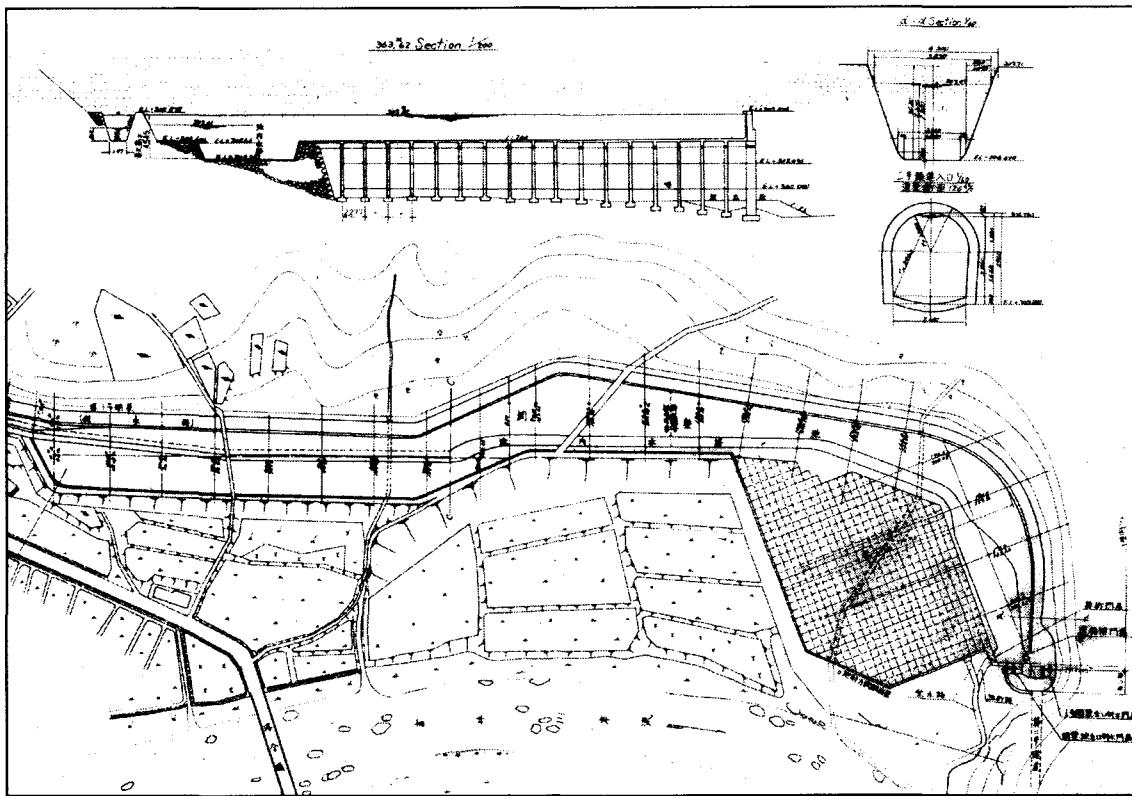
「布江調整池平面図及断面図」の部分(所蔵:中国電力)
